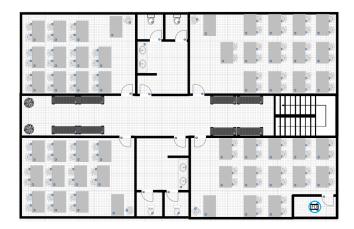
Planta do Primeiro Andar do Edifício 2
